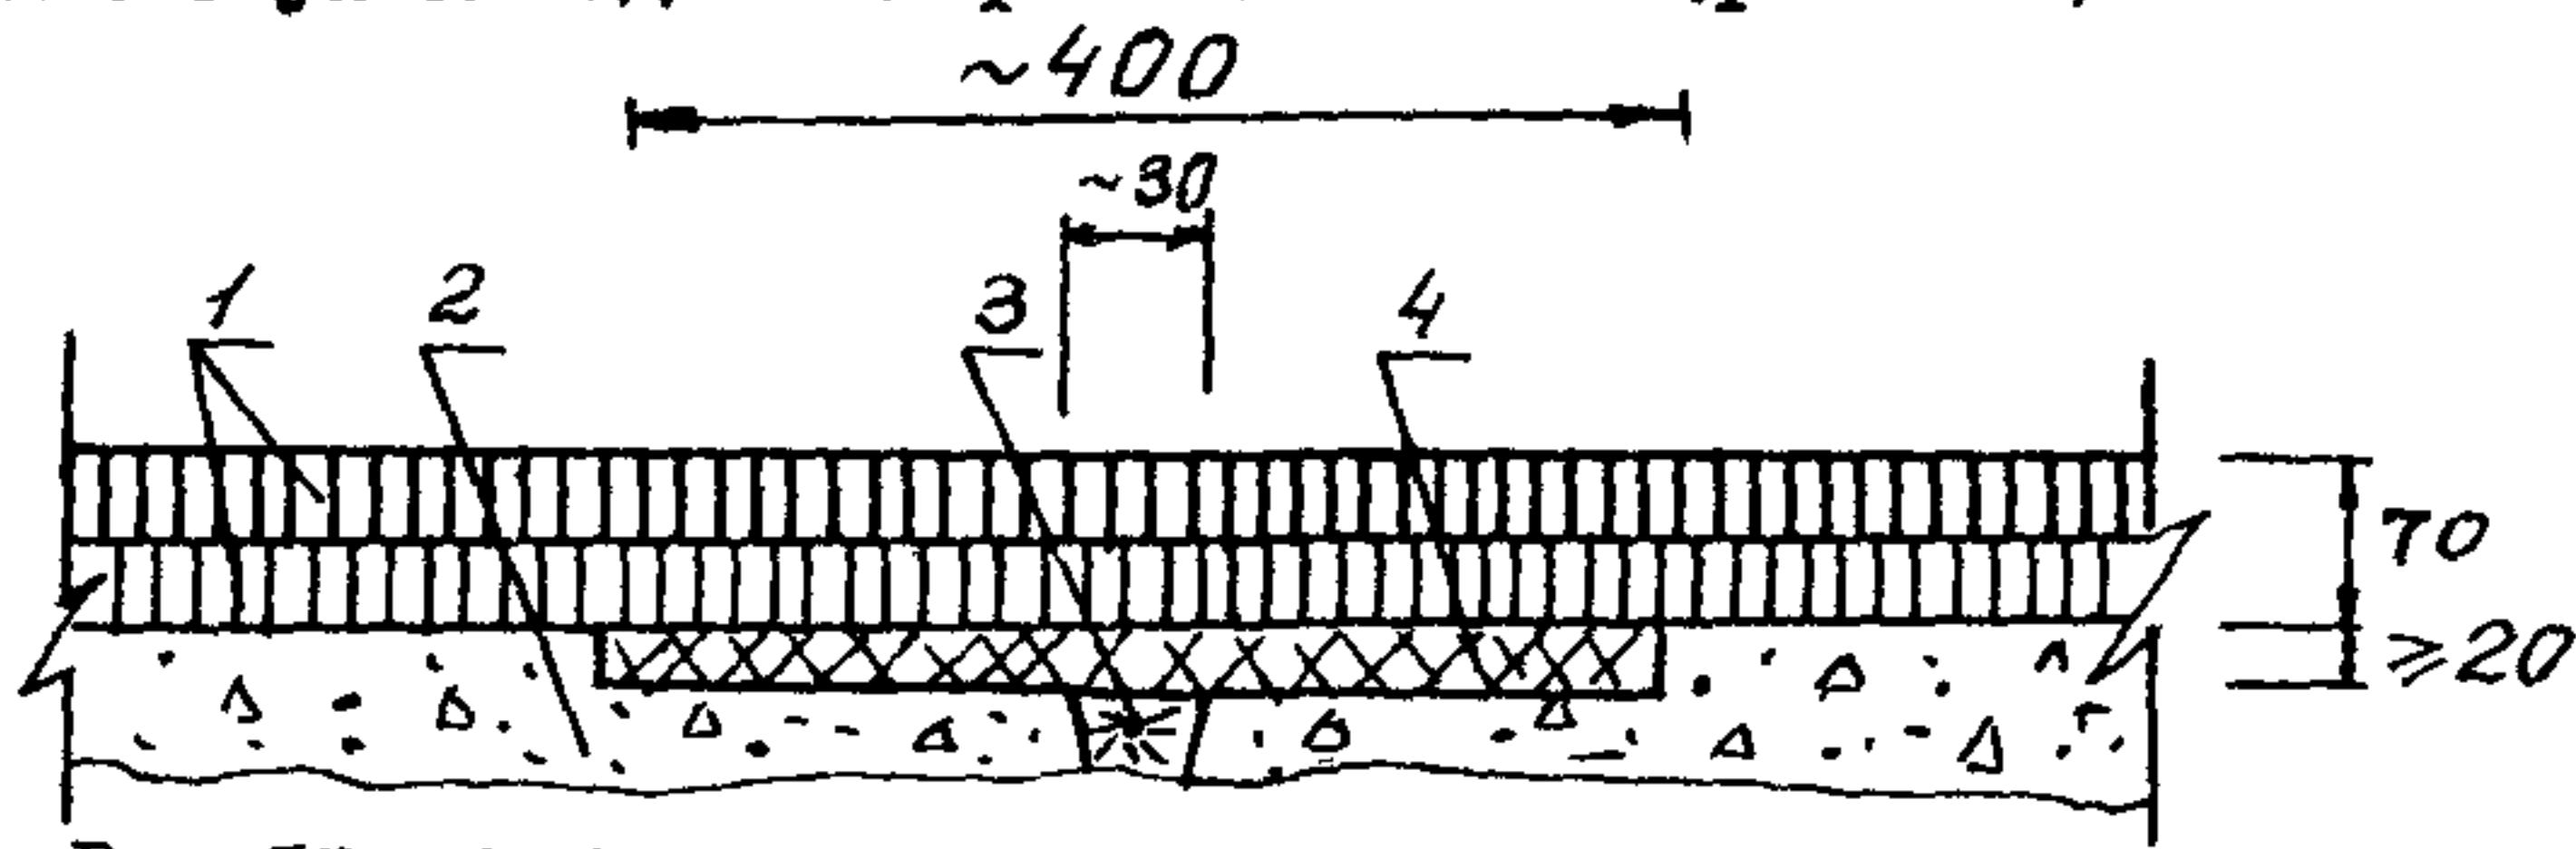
Асфальтобетонные слои над швом закрытого типа при толщине защитного слоя более 60 мм: 1—двуслойное асфальтобетонное покрытие; 2—защитный слой; 3—уплотнитель; 4—холодный асфальтобетон
